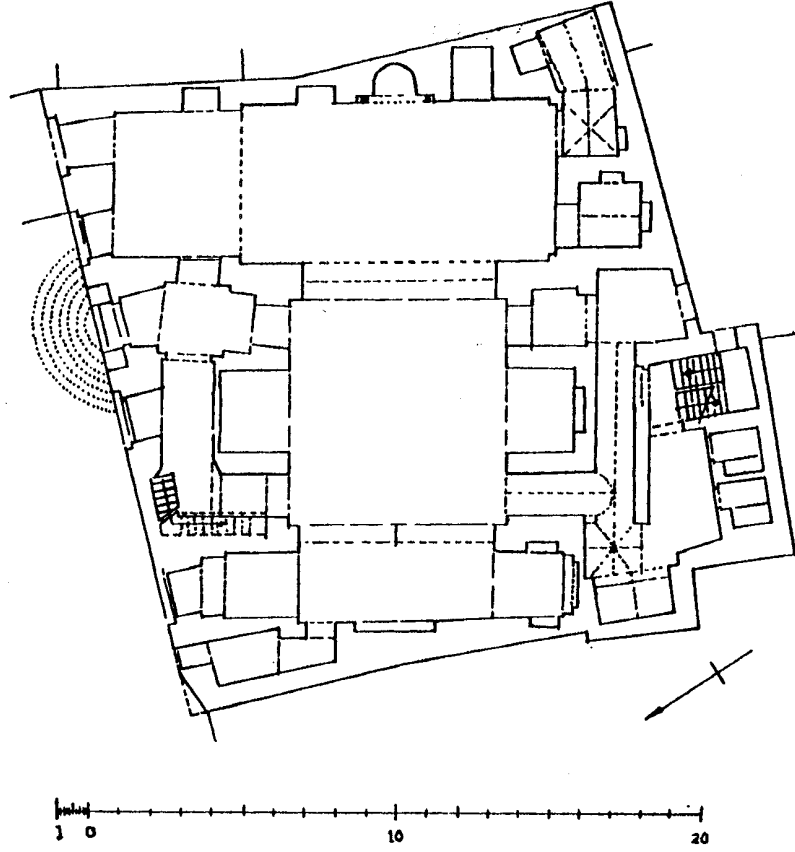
مسقط أفقي لمدرسة الأشرف برسباي بالقاهرة (عن Kessler)
